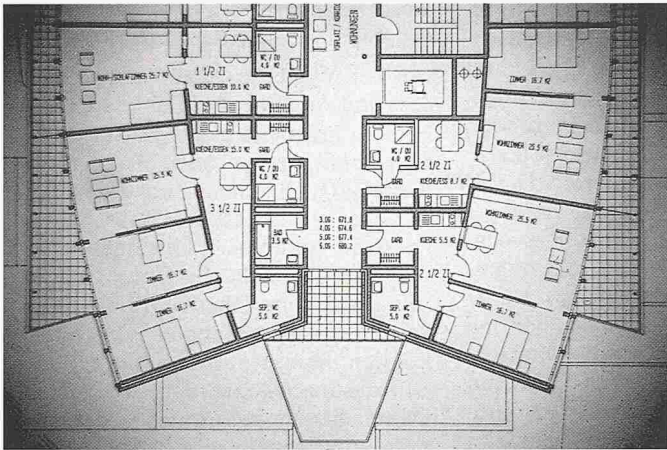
/11. Grundriss Bauprojekt, Plan ausgeplottet und 2D-Überarbeitung am Bildschirm (Projekt Tertianum Adlerberg, St. Gallen)
